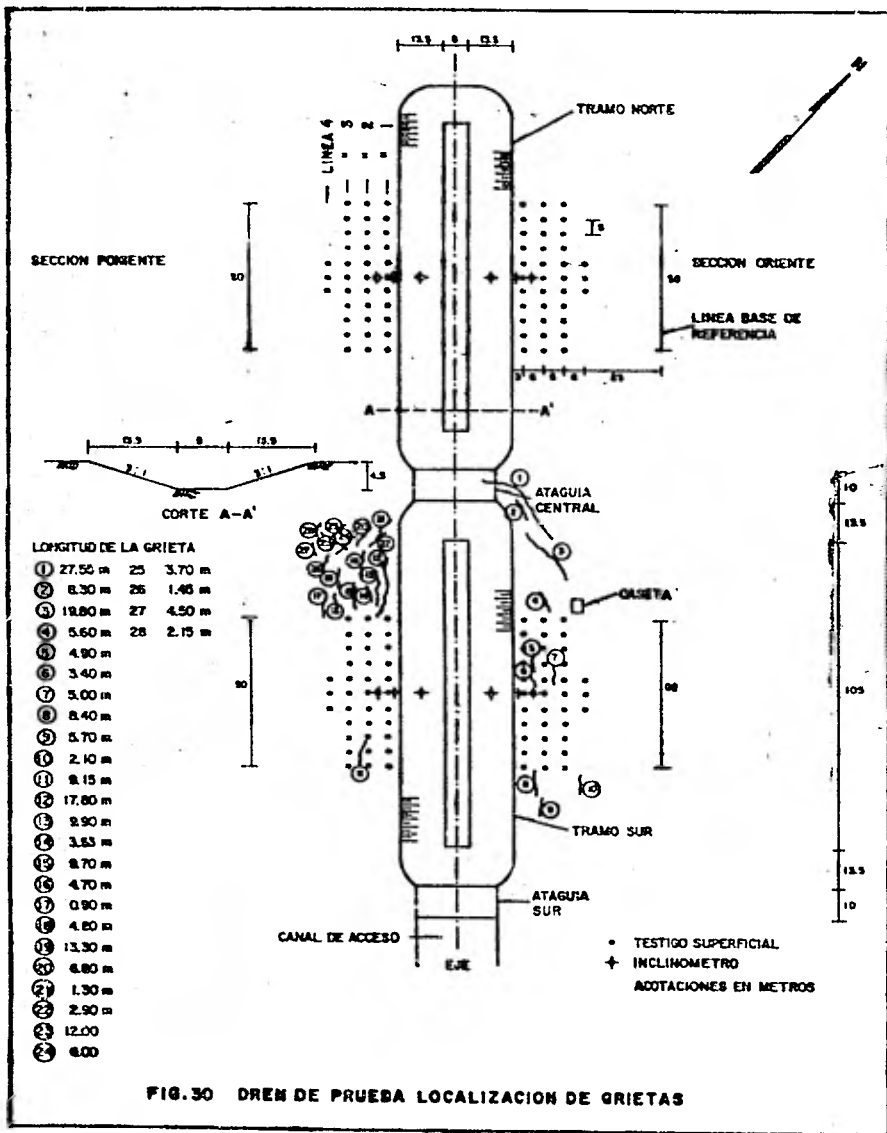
DREN DE PRUEBA LOCALIZACION DE GRIETAS
